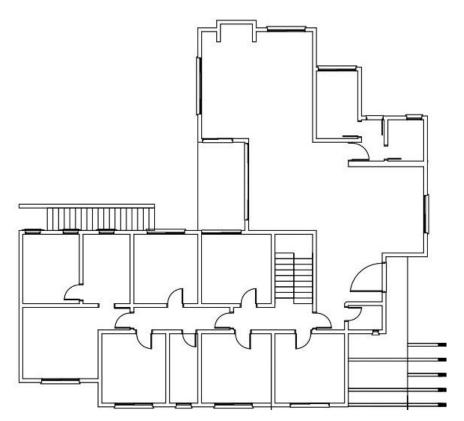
Planta baixa Pavimento superior Fonte: Projeto Arquitetônico (2017)
